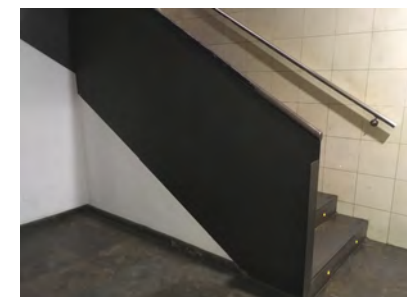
No existe espacio bajo escalera que pueda suponer riesgo
